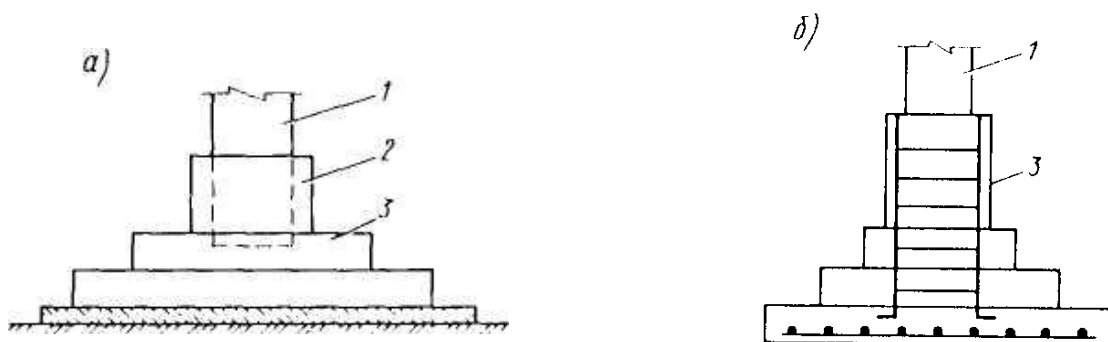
Конструкции монолитных железобетонных фундаментов:
